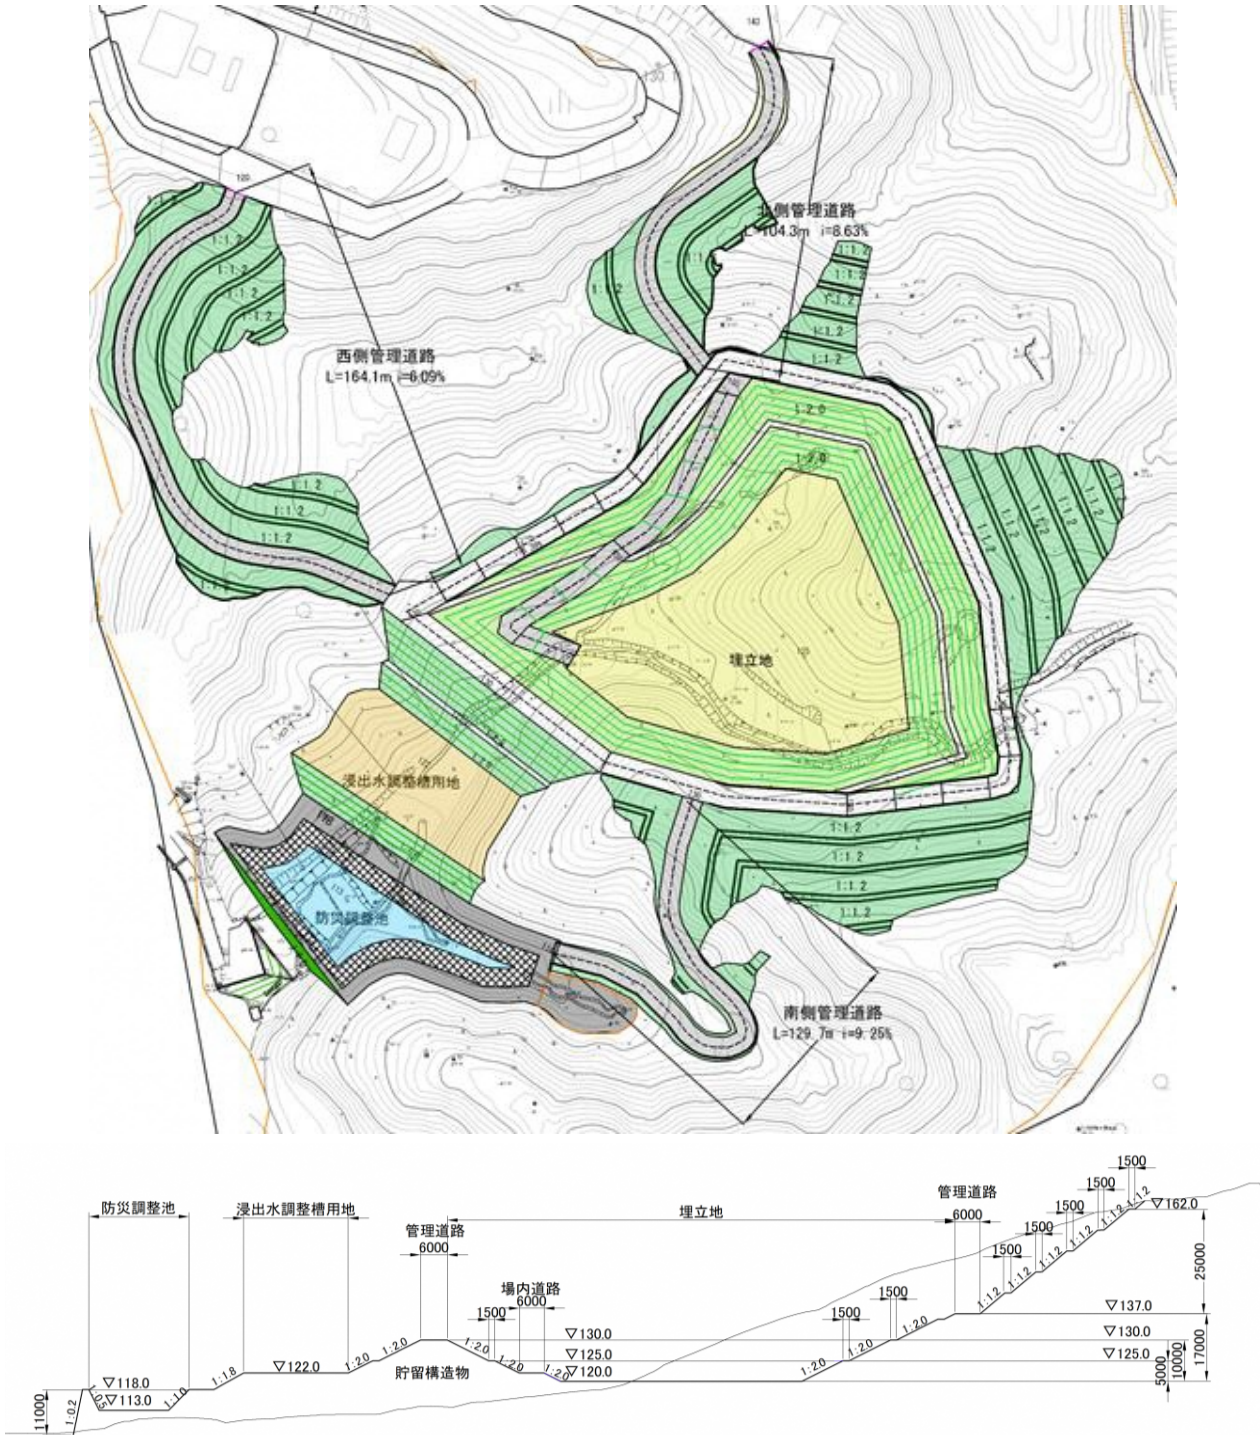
基本計画 (案1) 平面図 (上)、標準断面図 (下)
